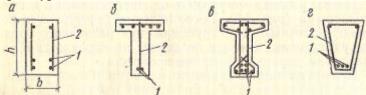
Поперечное сечение балок и схемы армирования: а- прямоугольное; б- тавровое; в- двугавровое; г- трапециевидное: 1- продольные стержни; 2- поперечная арматура.
